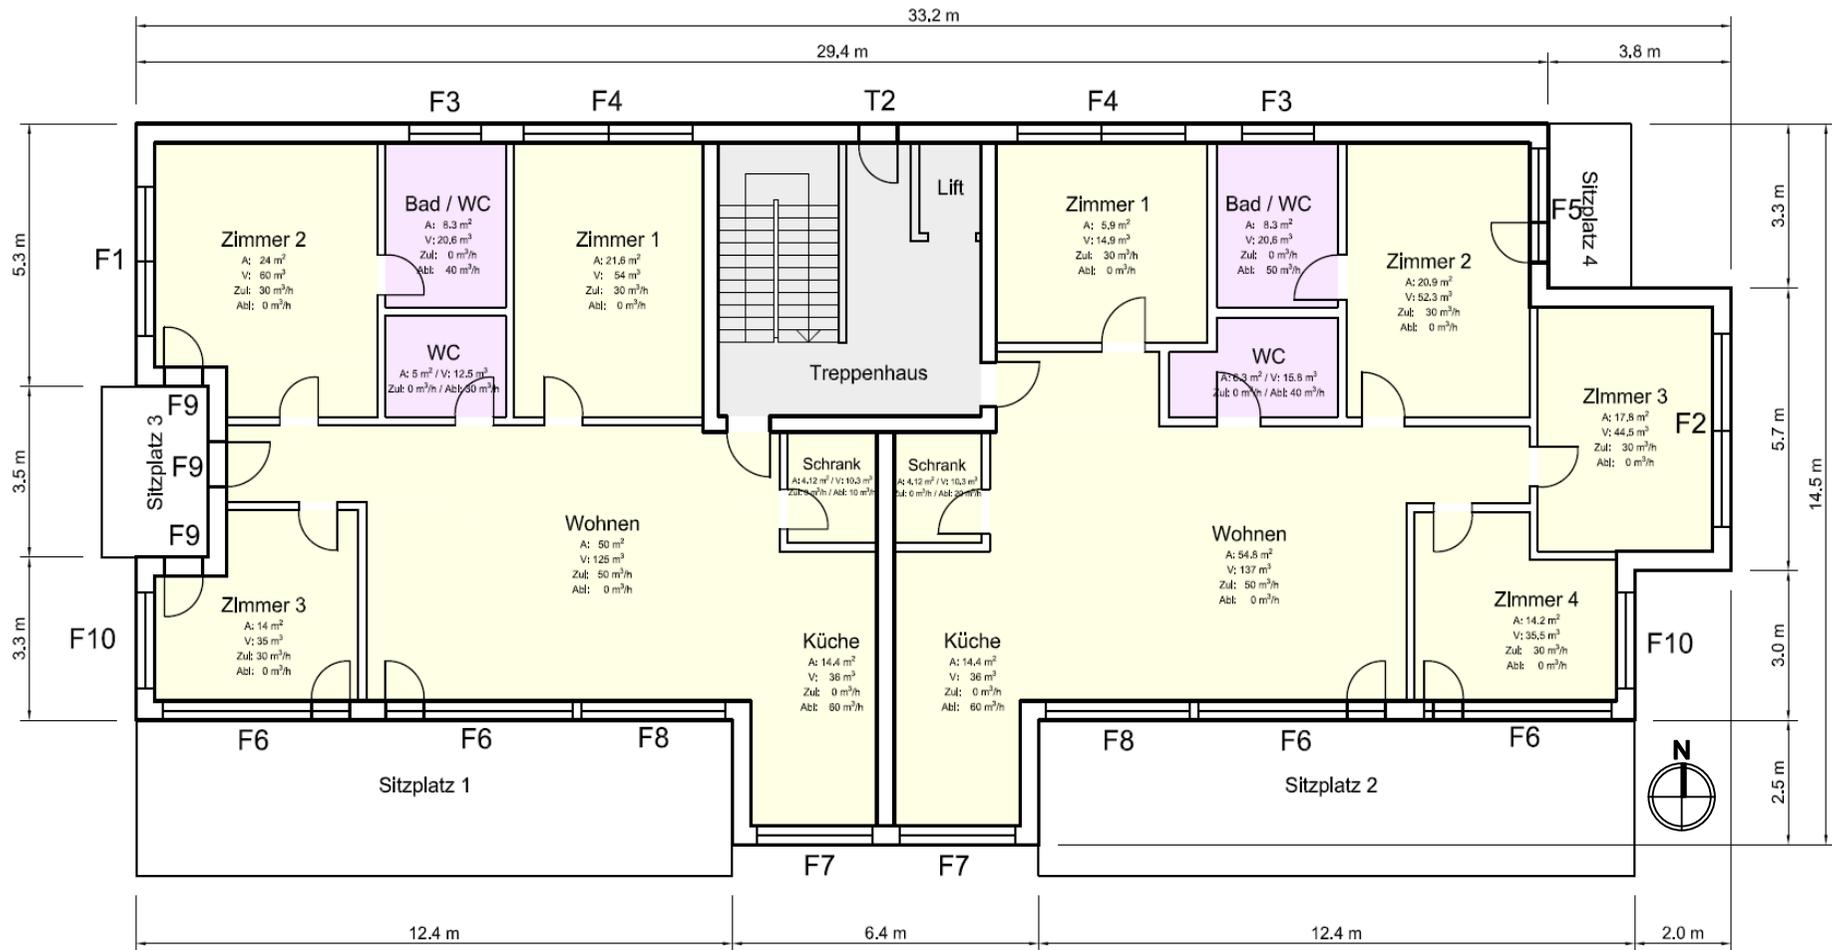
Grundriss und Zonenaufteilung des Erdgeschosses und der beiden Obergeschosse.
